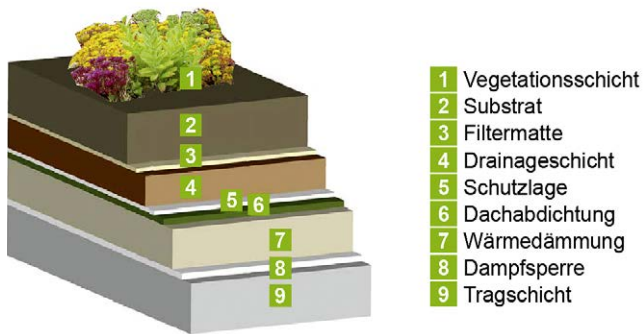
Beispielhafter Aufbau eines Gründaches (Warmdach)
